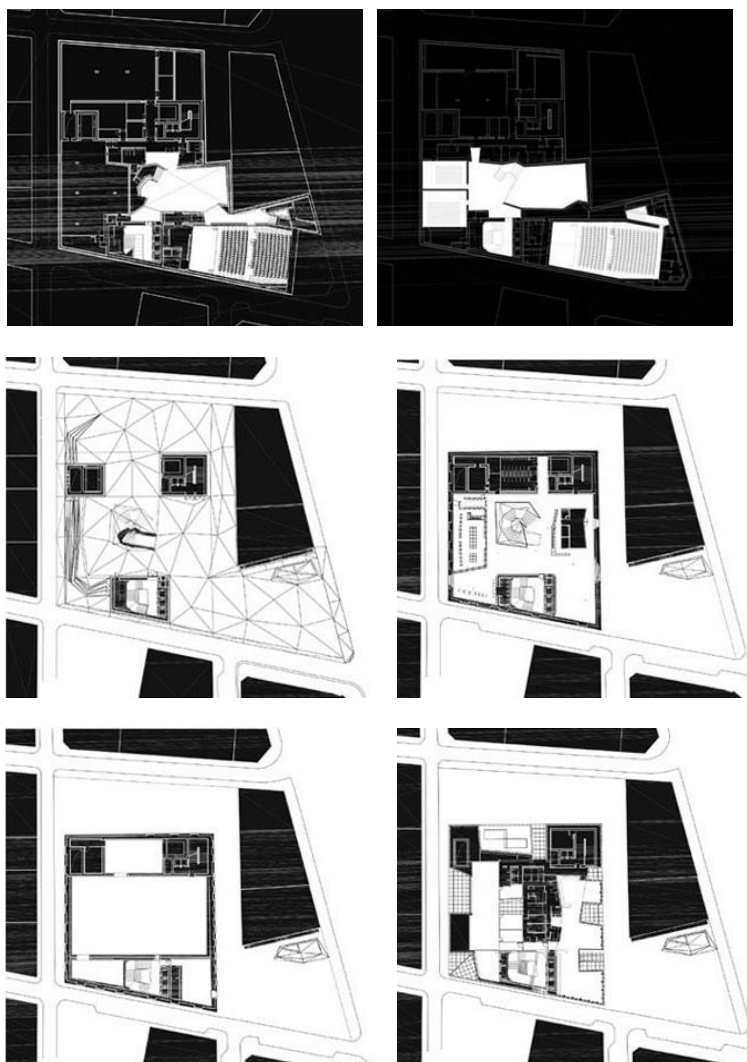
Plantas dos pisos: -2, -1, 0, 1, 2, e 3.
